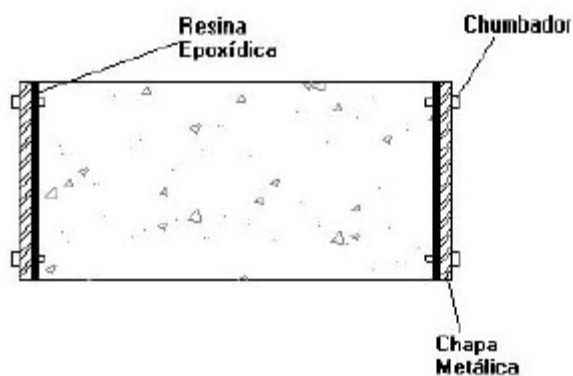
Reforço com chapas coladas e aparafusadas (RIGAZZO, 2003)
